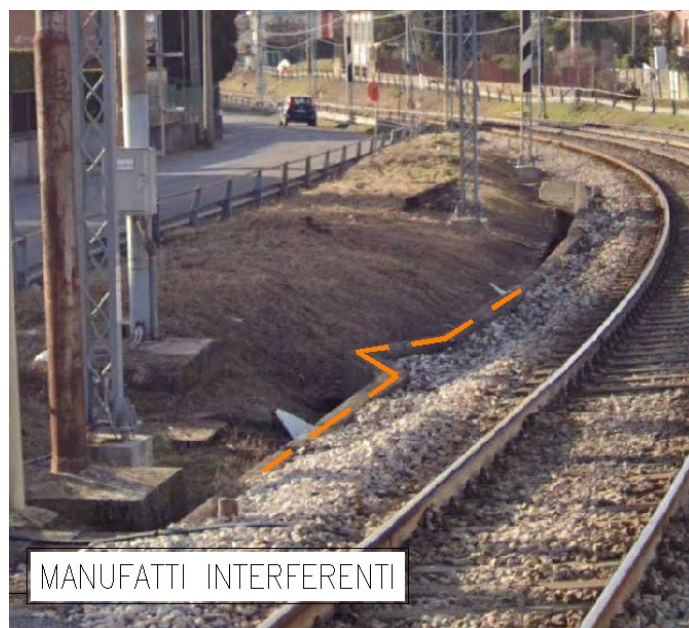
Vista in arancione della canaletta cavi FS lato via alla Fonte
